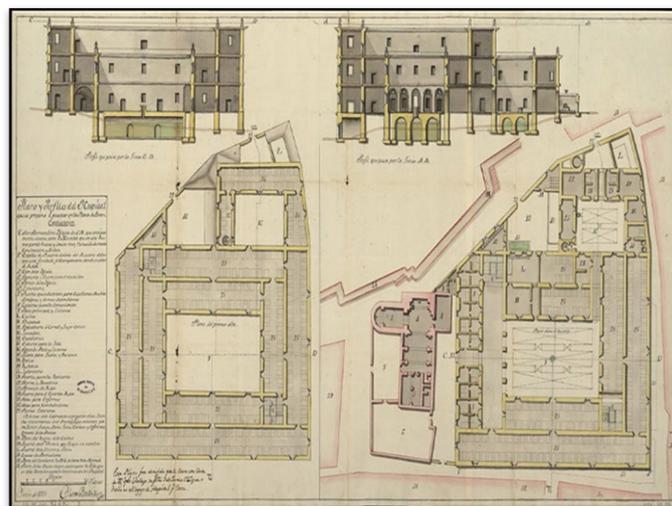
Plan et coupes de l'hôpital à exécuter pour la place d'Oran, juin 1737.
